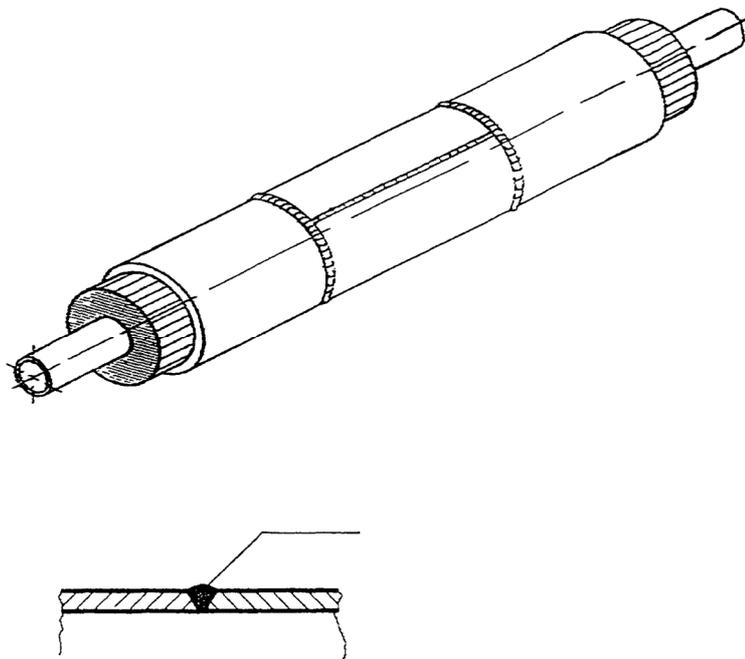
Конструкция клеевого стыкового соединения с разъемной металлической муфтой. 1 – стальная труба; 2 – сварной стык; 3 – полиэтиленовая оболочка; 4 – провод СОДК; 5 – муфта; 6 – пенополиуретан; 7 – герметик; 8 – пробки; 9 – клиновые замки.
